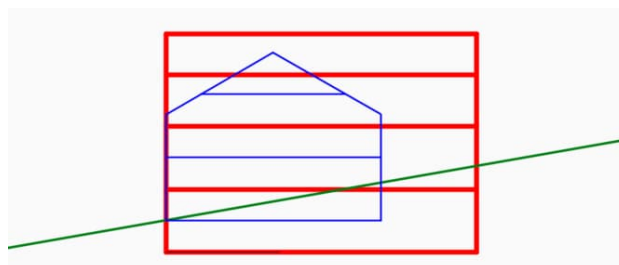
Bebauungskonzept Variante 2, Schnitt, ohne Maßstab, (grün = Geländeverlauf, rot = Schritt durch Traufseite des Gebäudes gemäß Antrag auf Vorbescheid, blau = Schnitt durch Giebelseite gemäß Plangebäude Variante 2)
